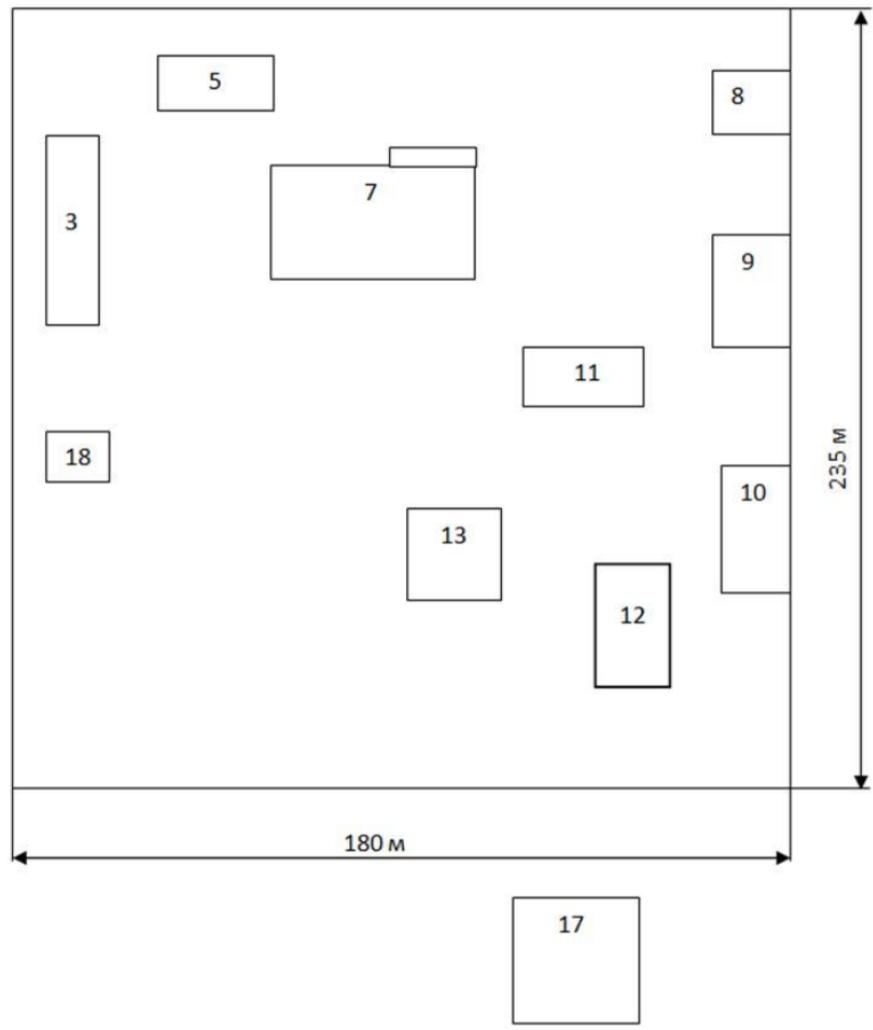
План производственной базы предприятия по ремонту и обслуживанию техники: 3 - теплая стоянка для автомобилей; 5 - столовая; 7 - главный производственный корпус; 8 - административно-бытовой корпус; 9 - цех ремонта бытовой техники; 10 - автосервис; 11 - кузнечно-сварочный цех; 12 - столярный цех; 17 - жилое здание; 13 - склад оборудования; 18 - котельная.
